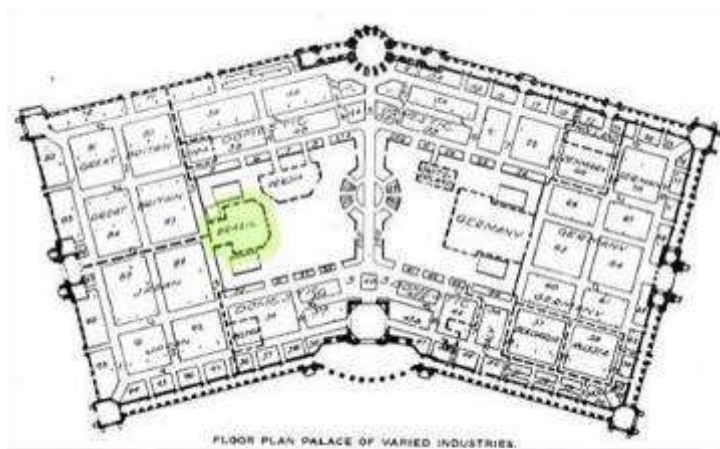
Planta do Palácio das Várias Indústrias (Fonte: planta - Oficial Guide L. P. E. - imagem M.H.M.)
